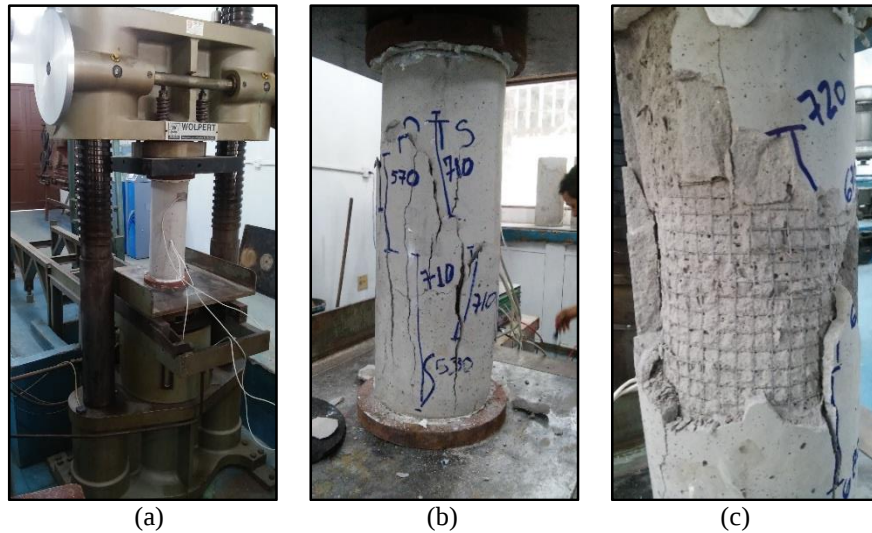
PCTS posicionado na prensa, (a) início da fissuração (b) e ruptura (c).
